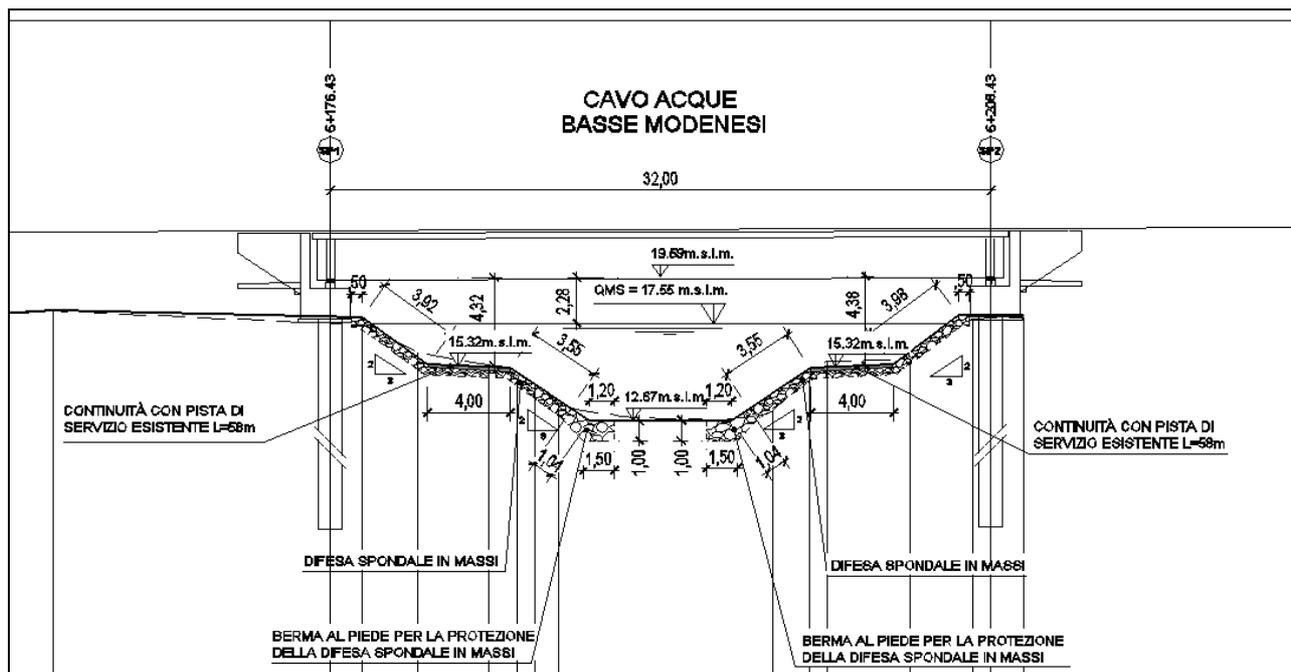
PARTICOLARE DIFESA SPONDALE
